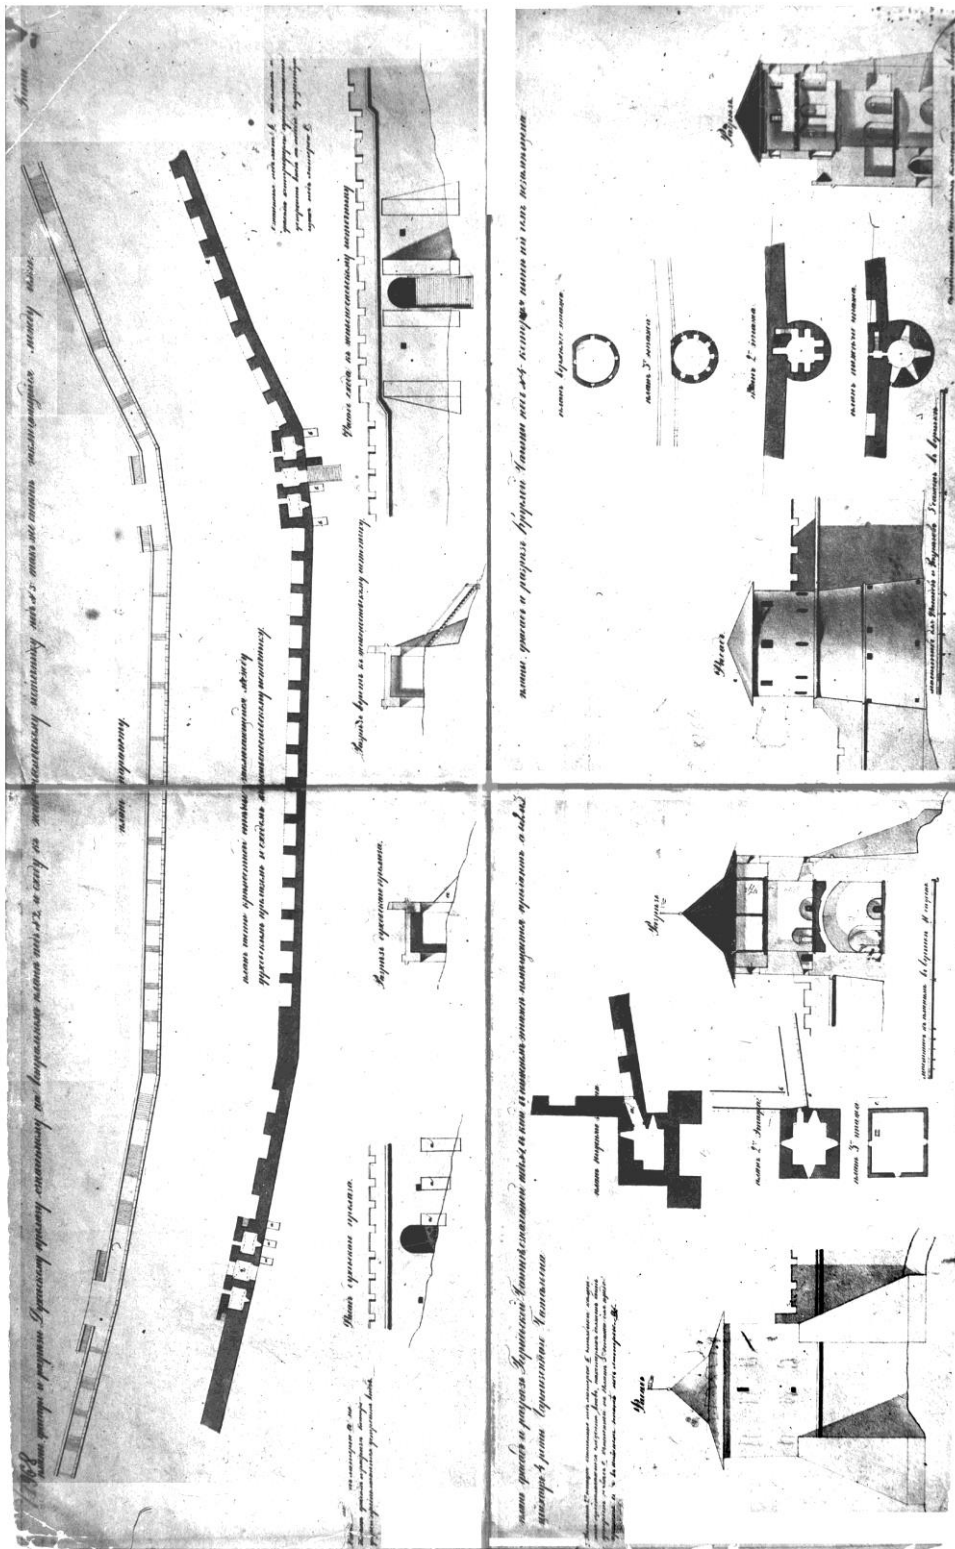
План и фасад Георгиевской и Круглой (Белой) башен и прясла стены между ними. Обмерный чертеж, середина XIX в.
